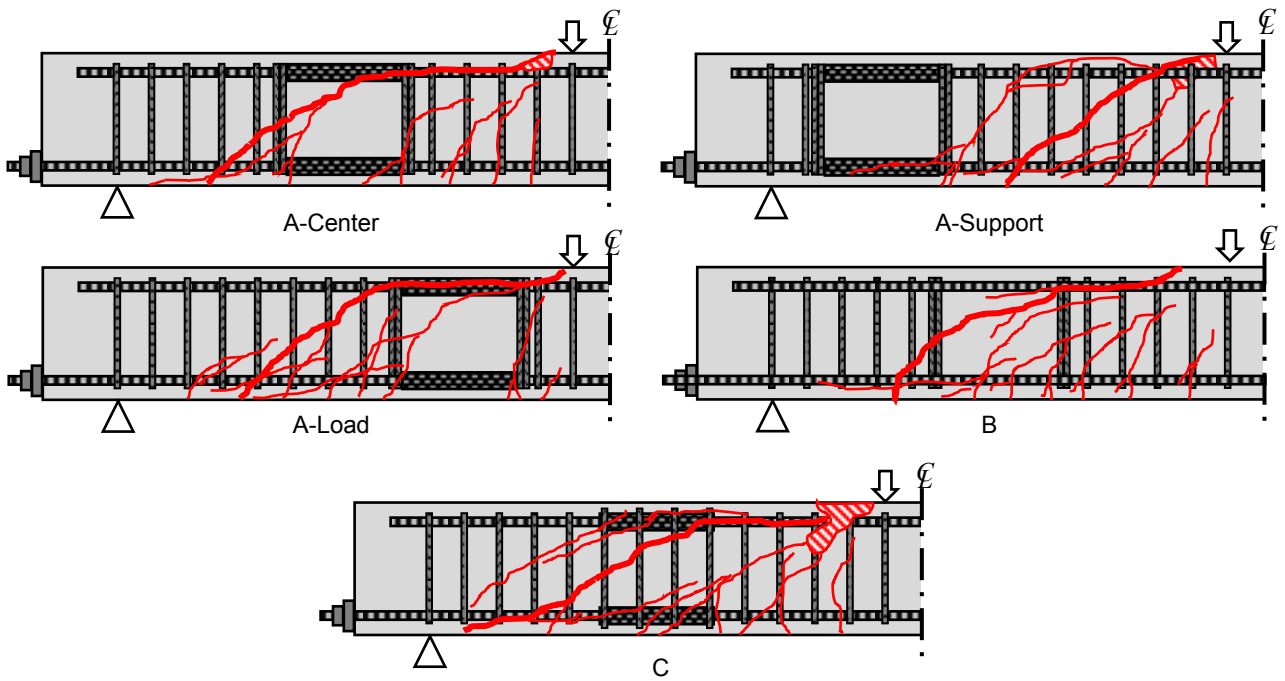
最大荷重時のひび割れ性状（太線は顕著な斜めひび割れ，斜線部は圧壊部）
